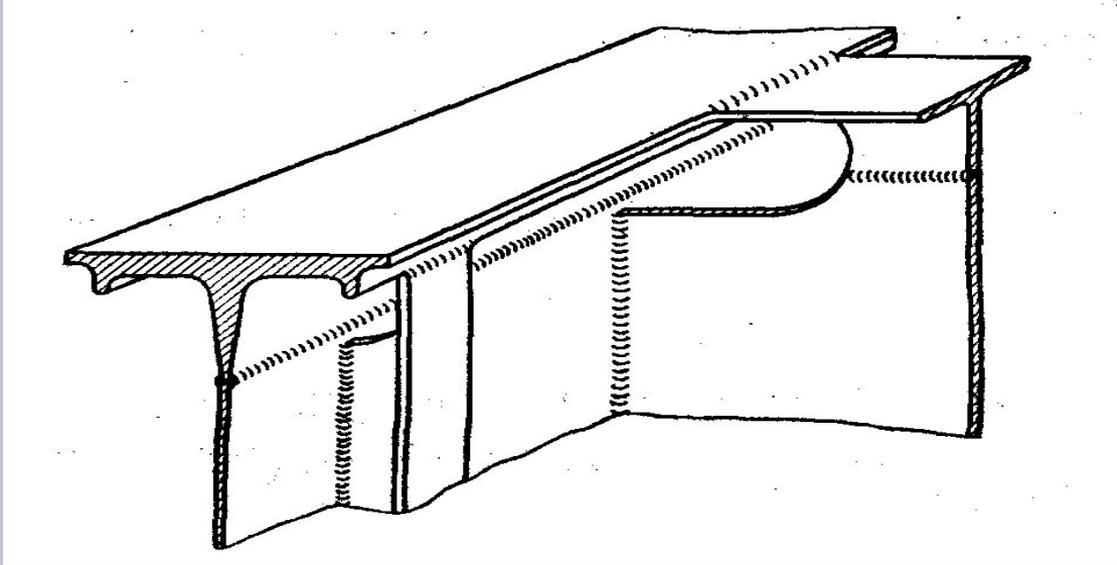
Конструкция сварного узла балок из алюминиевых сплавов
